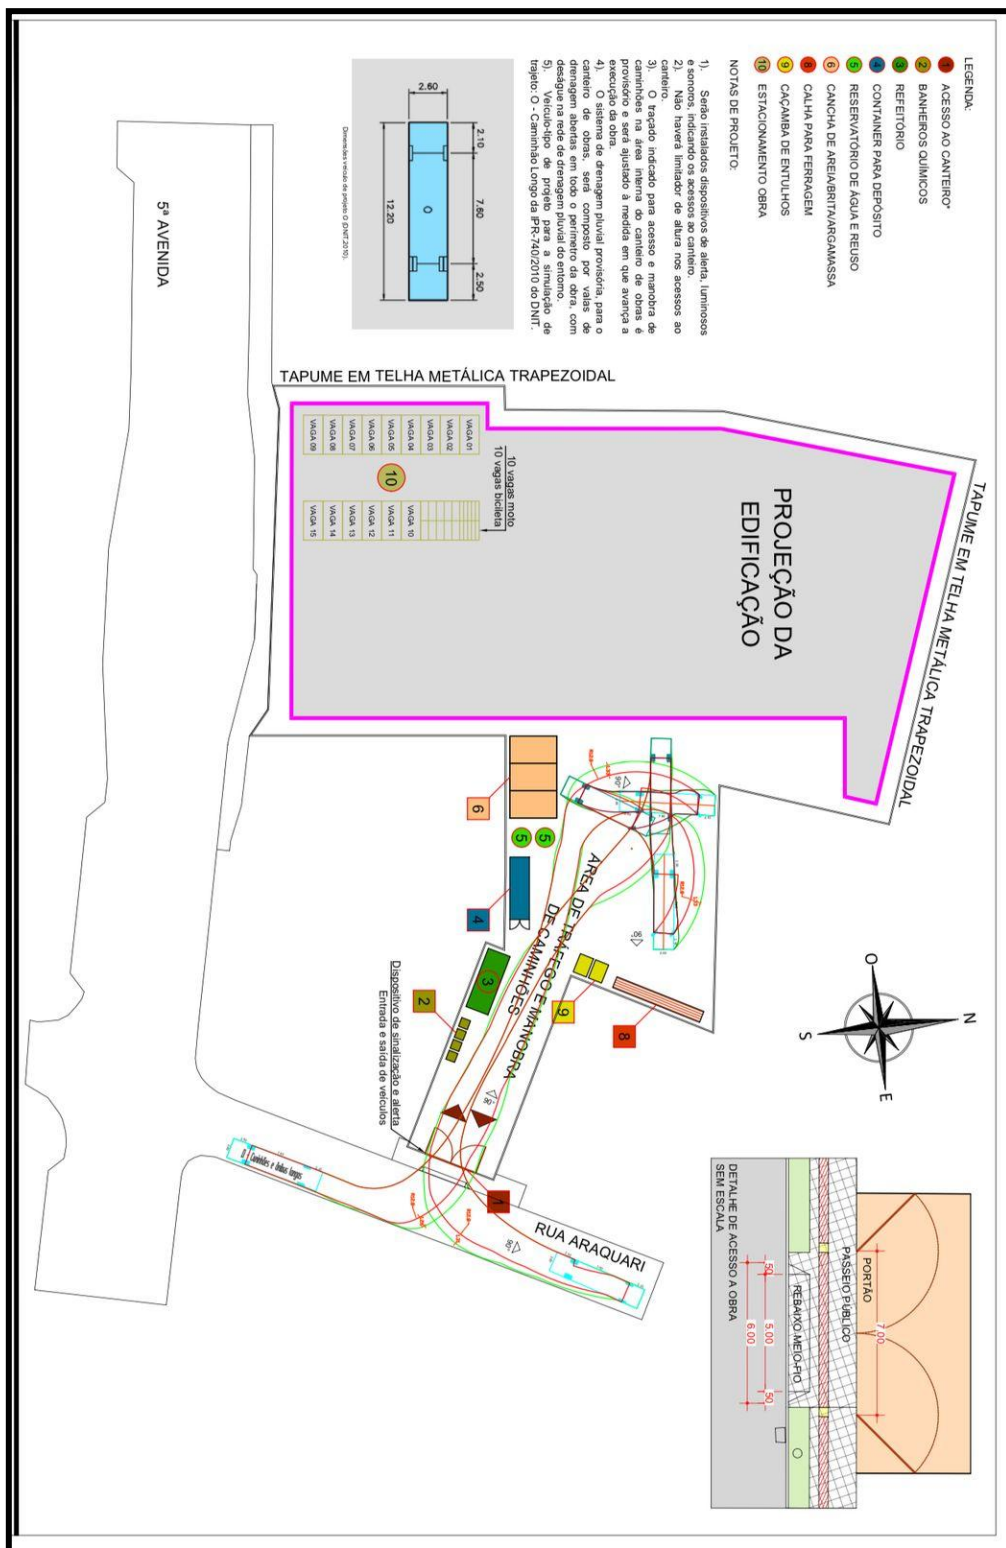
2ª FASE Canteiro de Obras. Fonte: Projeto Canteiro de Obras, 2024.
